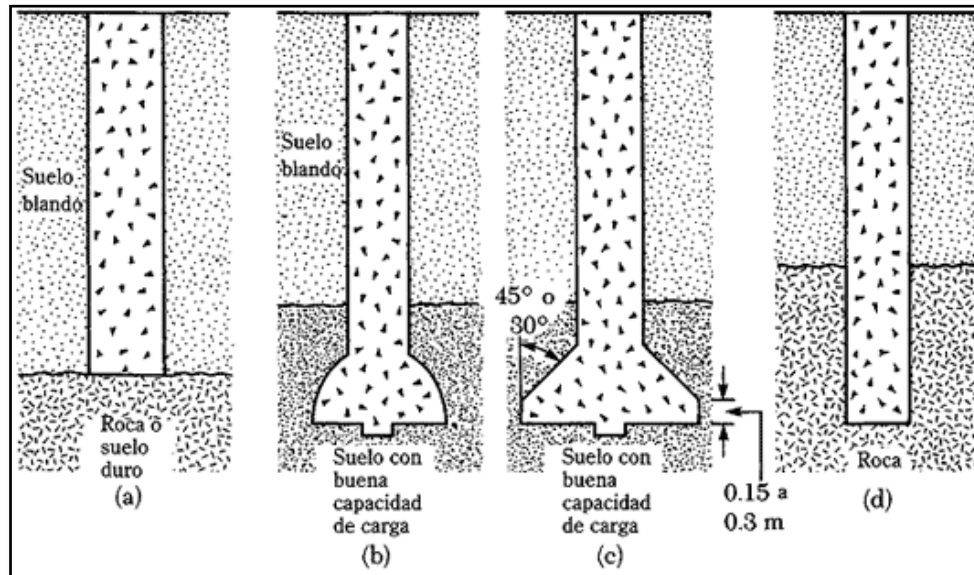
Tipos de pila perforada: a) pila recta; b) y c) pila acampanada; d) pila recta empotrada en roca.
